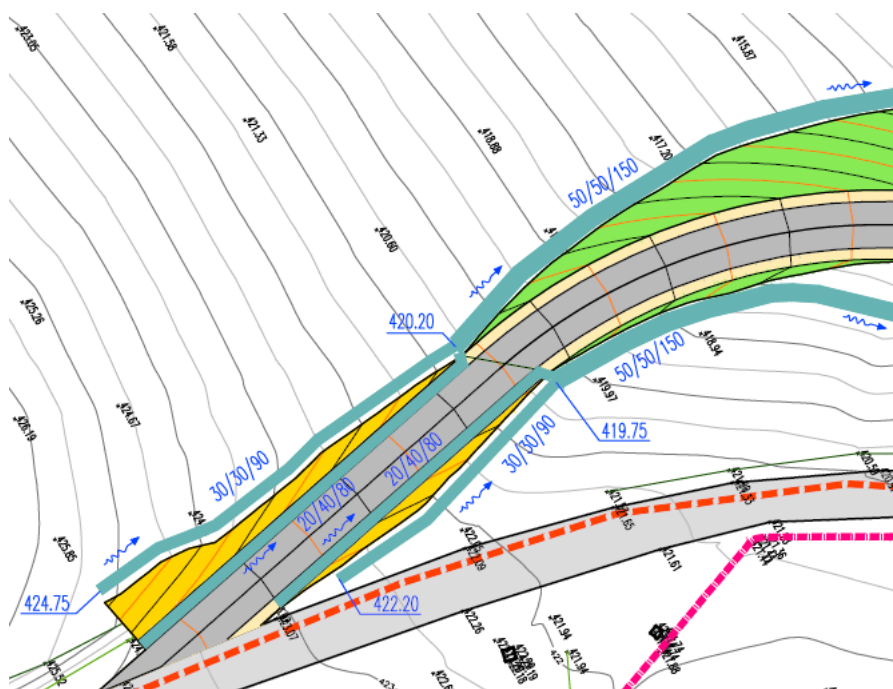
Planimetria di progetto della rete idraulica di intercettazione ed allontanamento delle acque esterne alla postazione (stralcio inizio strada di ingresso).
